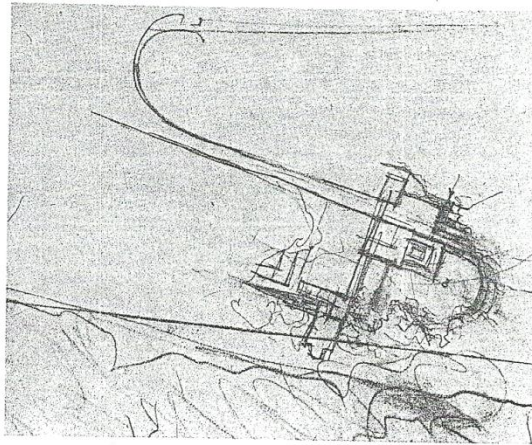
Frank Lloyd Wright: Croquis de la Booth House. Glencoe Ill, 1913.
